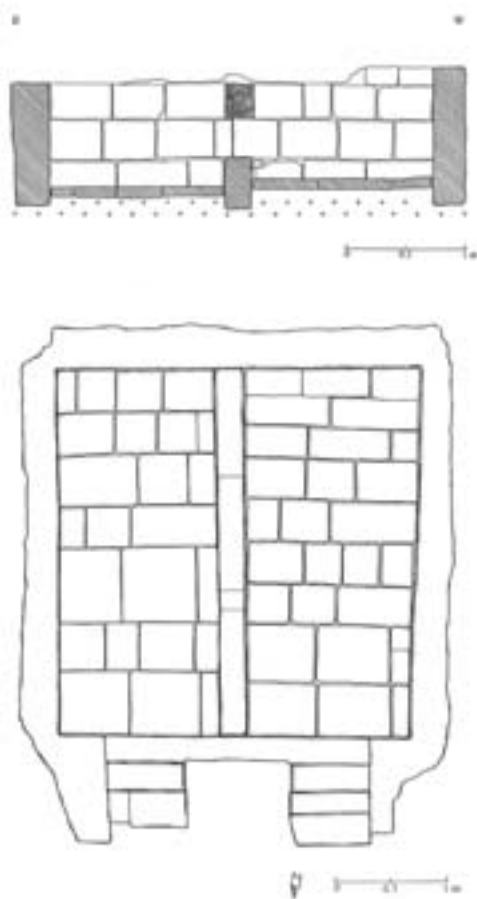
Planta y alzado de la cripta de los Maluenda.
